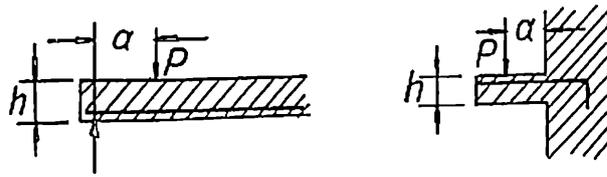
12. Влияние высоты балок l/h или же расстояния a/h от сосредоточенных нагрузок у опоры на прочность на сдвиг балок без арматуры, работающих на скалывание ($R'_{вк} = 2000 \text{ N/cm}^2$) согласно опытам [2.24]
